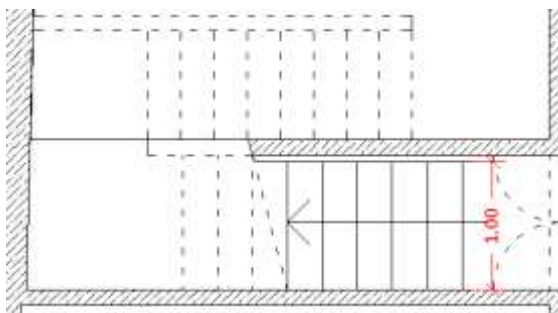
Representação em planta da largura da escada que interliga os pavimentos 1 e 2 (SRU, 2023).
